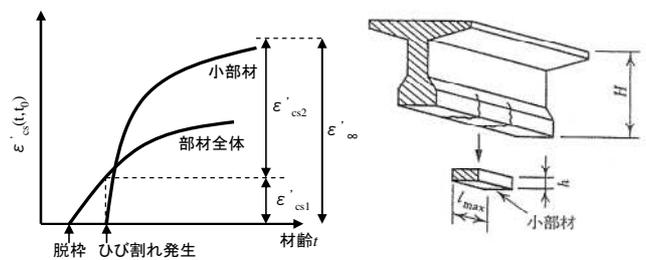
ひび割れ間のコンクリートの収縮の評価方法⁷⁾
